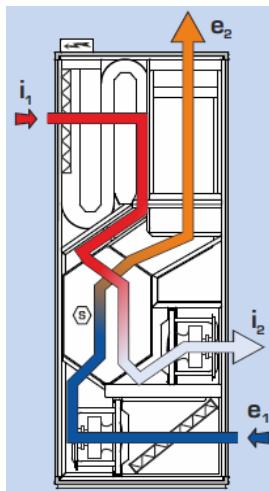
Chladenie zabezpečené nočným strojným vetraním
